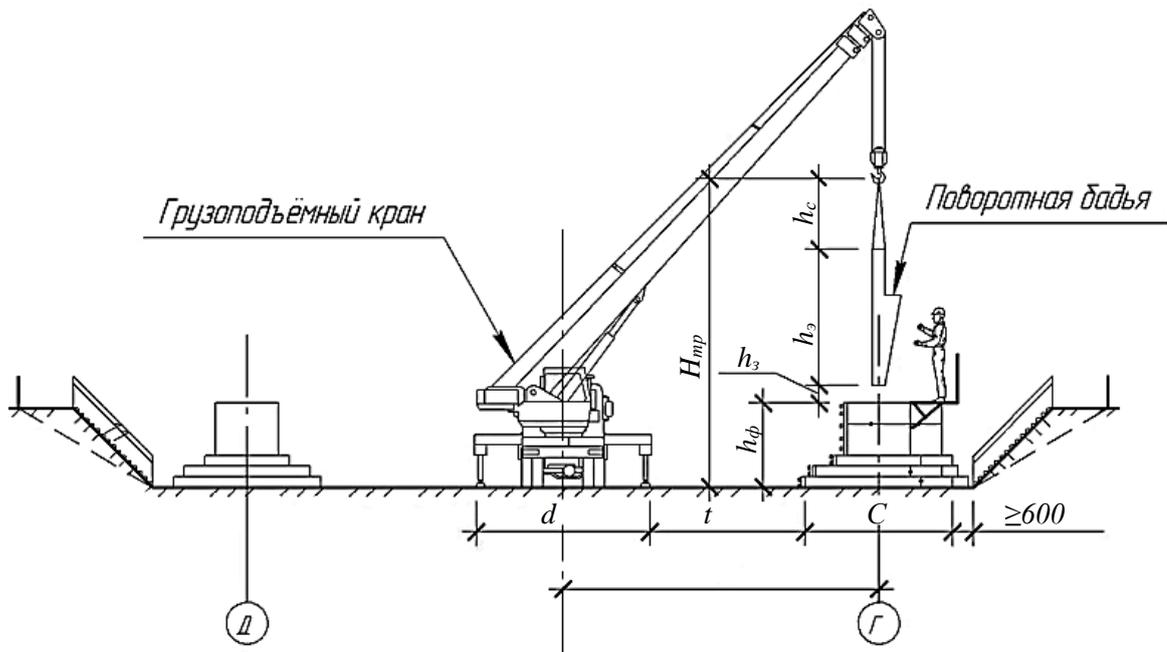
Схема к определению $H_{тр}$ и $L_{тр}$ при бетонировании фундаментов по схеме «кран-бадья» (при расположении крана в котловане)
